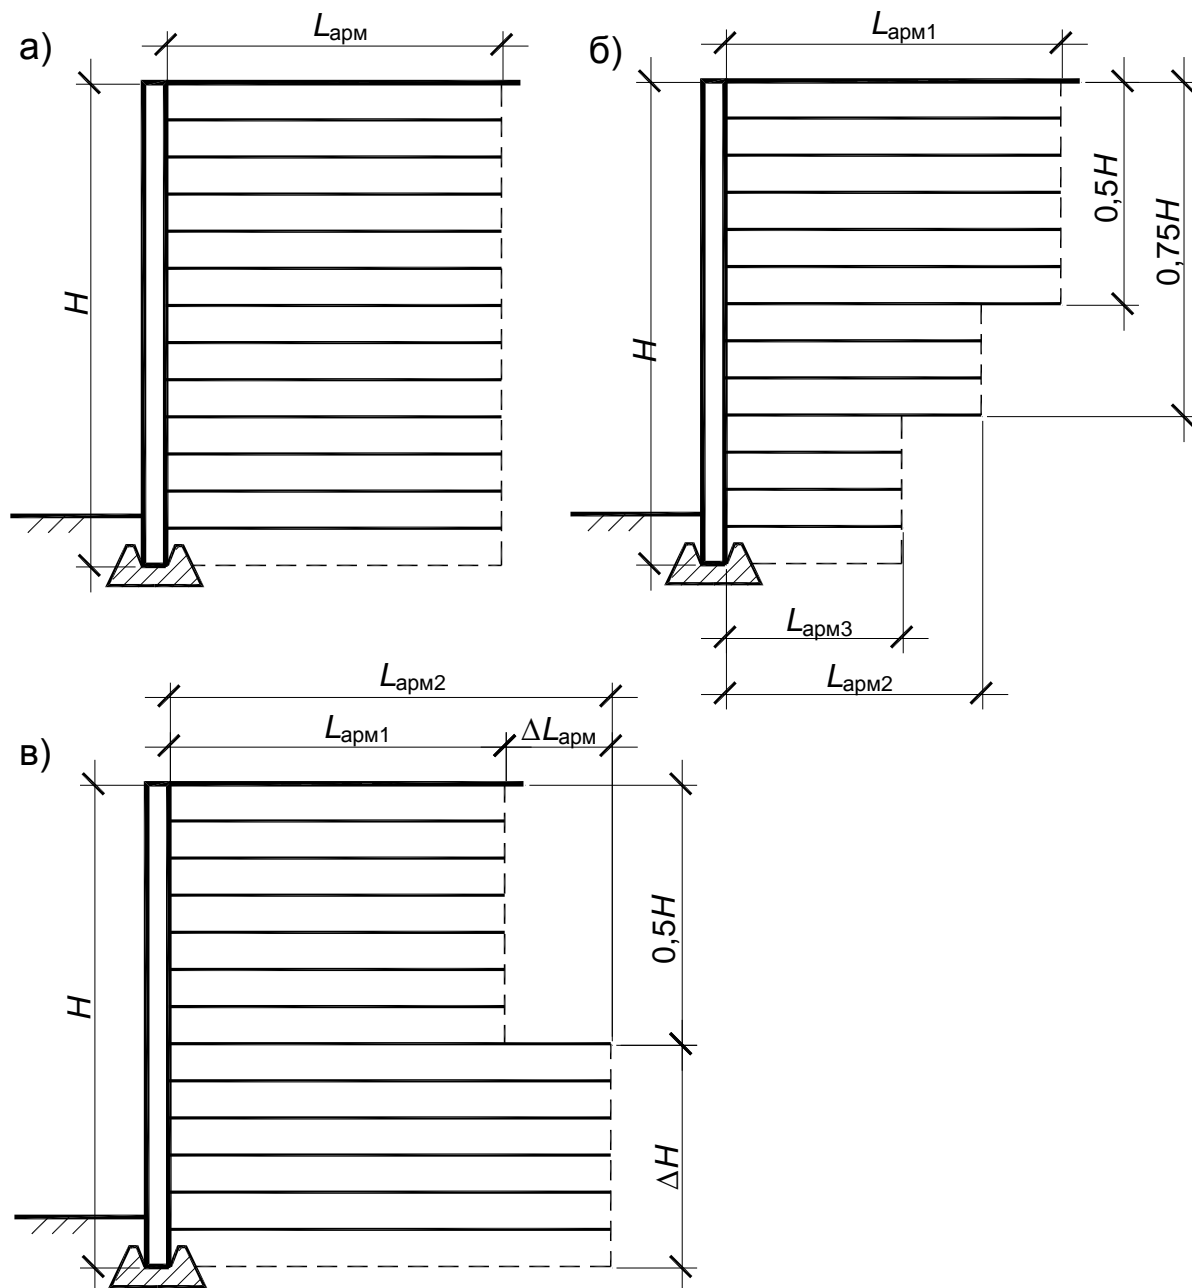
Конструкция армогрунтовой подпорной стены
